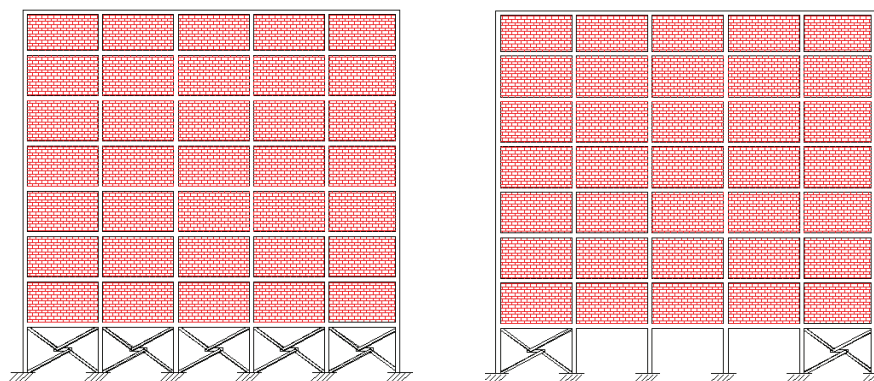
Disposição das soluções de reforço adotadas para a direção longitudinal – k-bracing.
